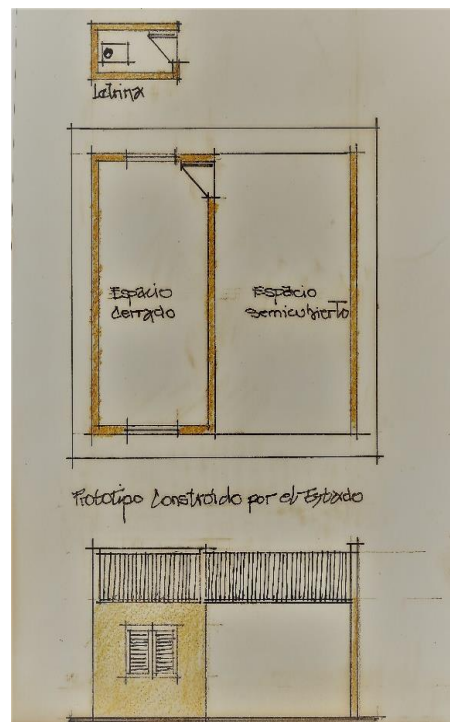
Viviendas construidas por el estado para reemplazar viviendas-ranchos.
